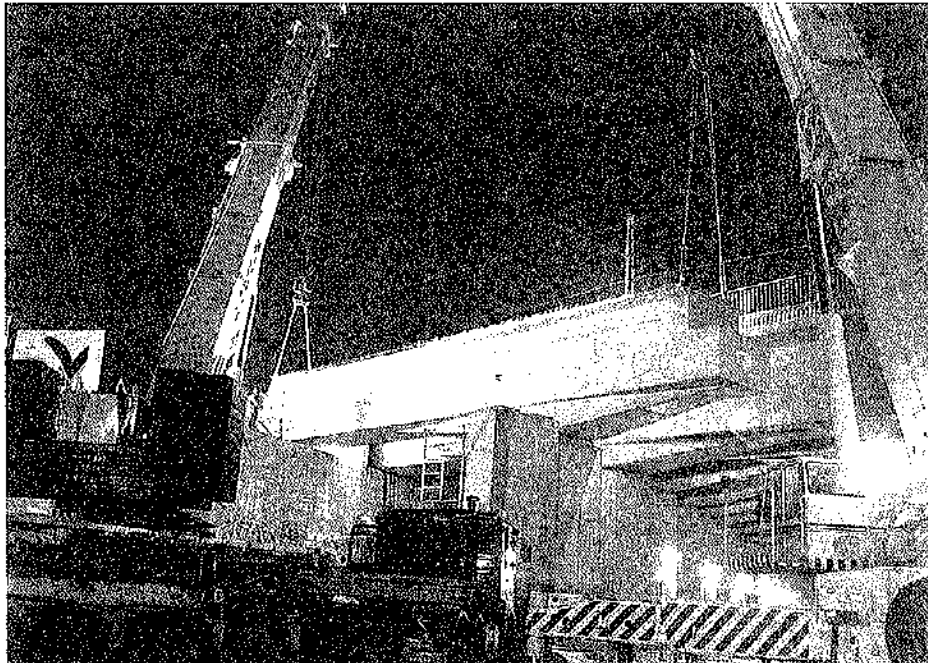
Montaje nocturno de las vigas laterales del Puente de los tres ojos en la M-30 de Madrid. Luz central: 50 m.
